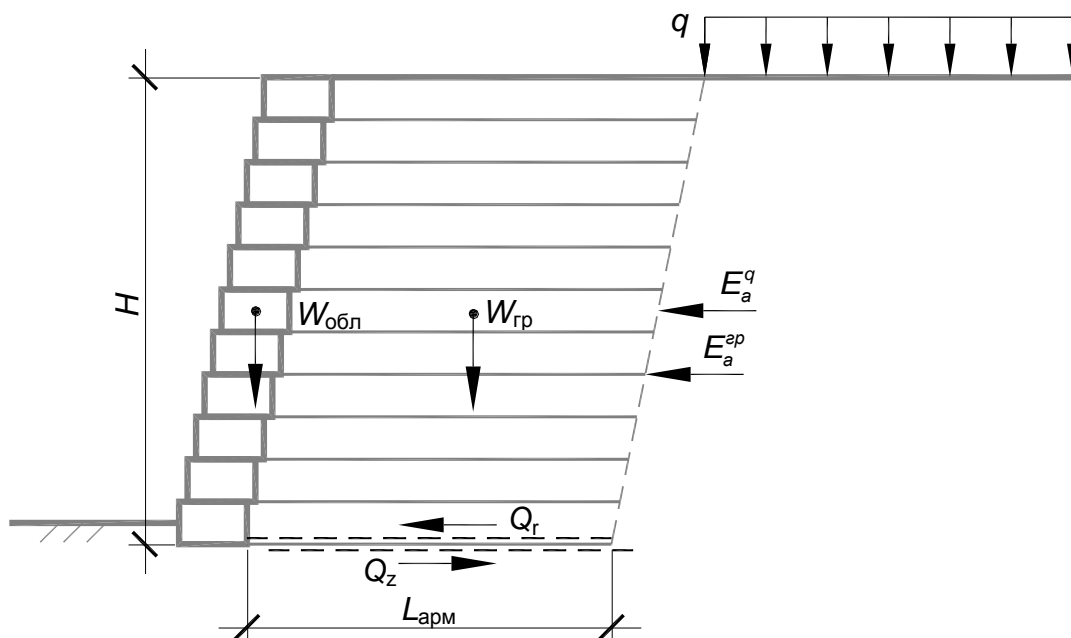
Расчетная схема при проверке устойчивости положения на сдвиг по подошве армогрунтового блока
